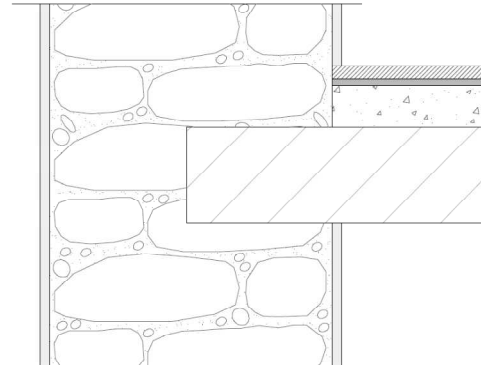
Fachada-Forjado (por vigueta). Zona este. Estado original.
